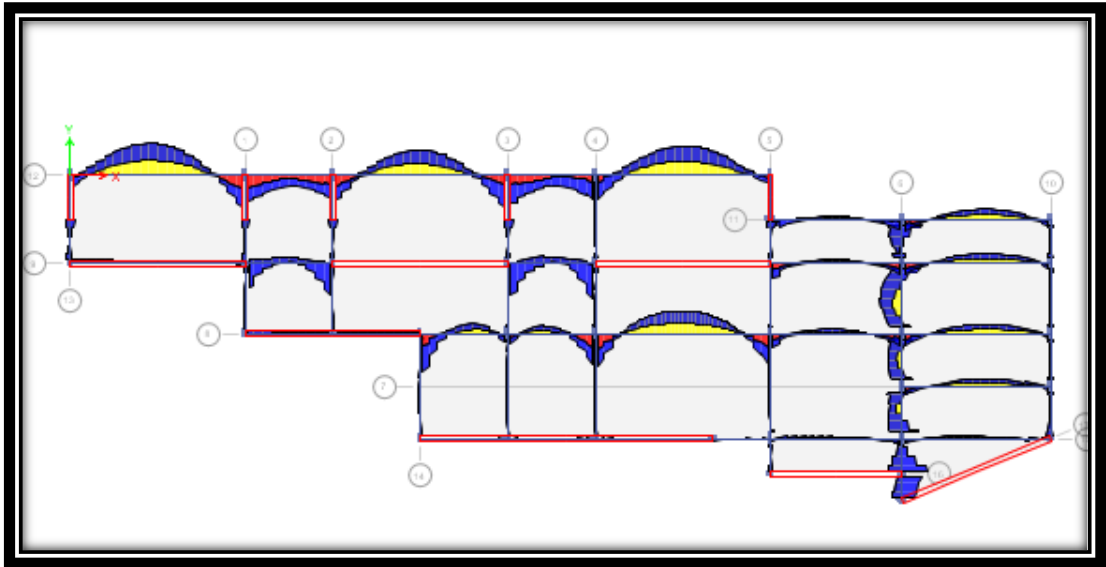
, Momentos flectores en vigas en toda la estructura (vista en planta)
